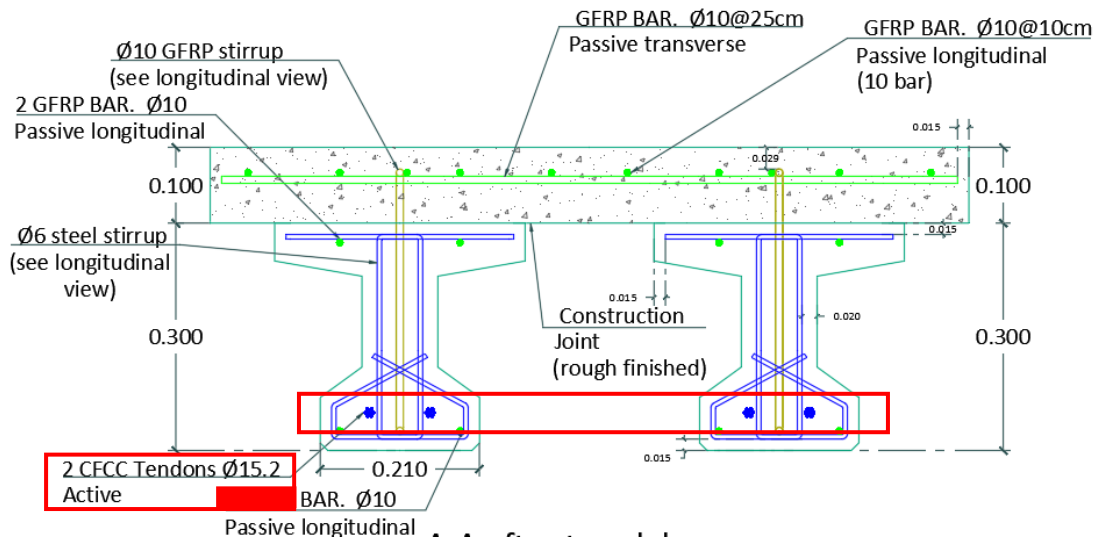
Disposición de la armadura activa de CFRP en las vigas
